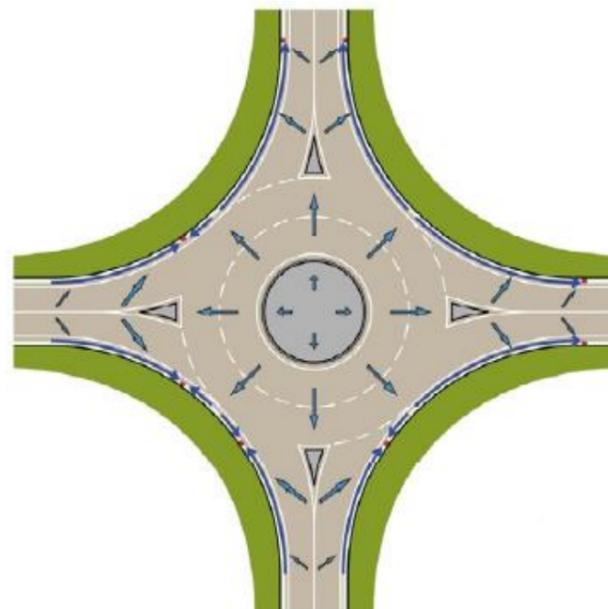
Detalle tipo del drenaje de glorietas (Fuente: Instrucción 5.2 I.C. Drenaje Superficial)
